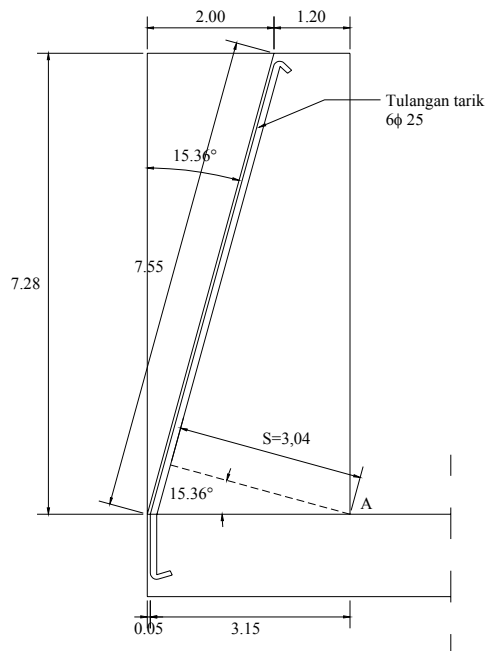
Penulangan Tembok Penahan Tanah Bangunan Pengambilan.
